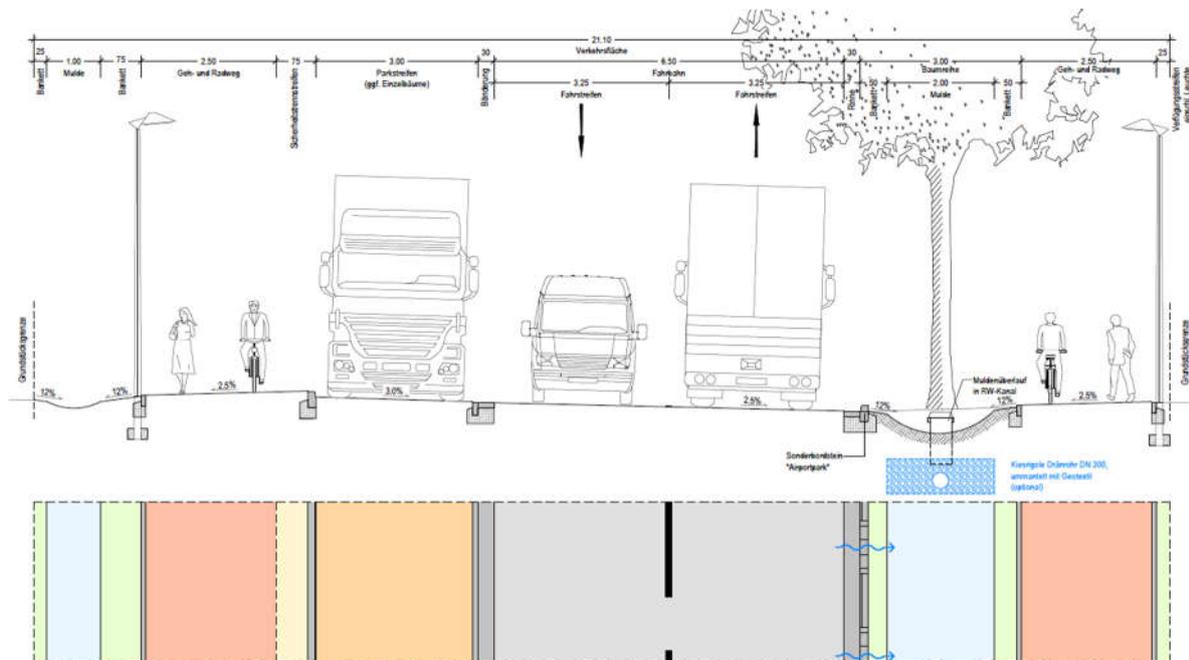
Regelquerschnitt Planstraße B; Planungsbüro Hahm Januar 2022
